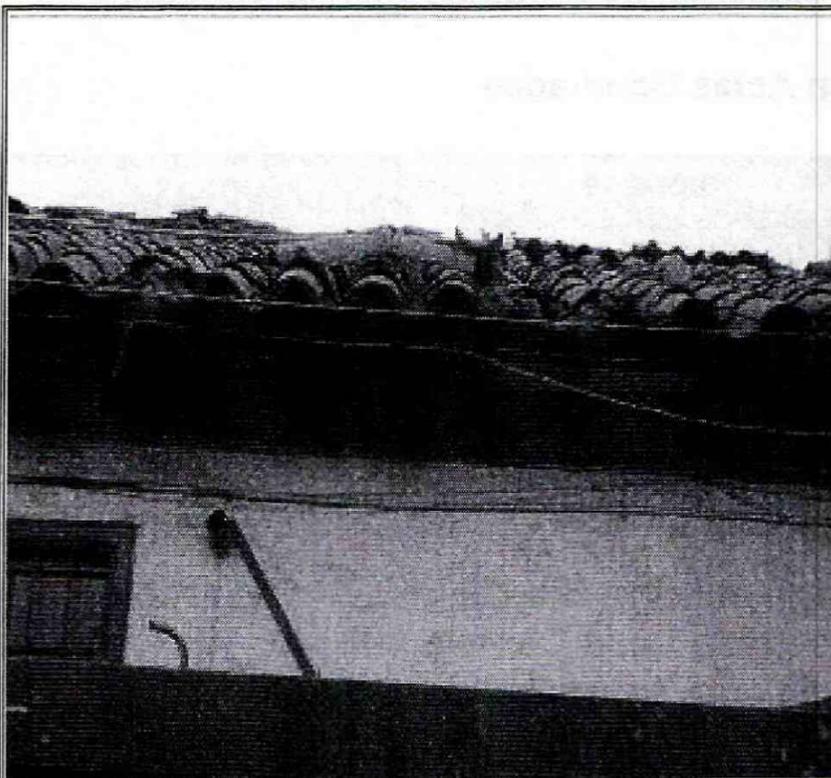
Desprendimiento de tejas de la estructura de cubierta de "La Casona"
